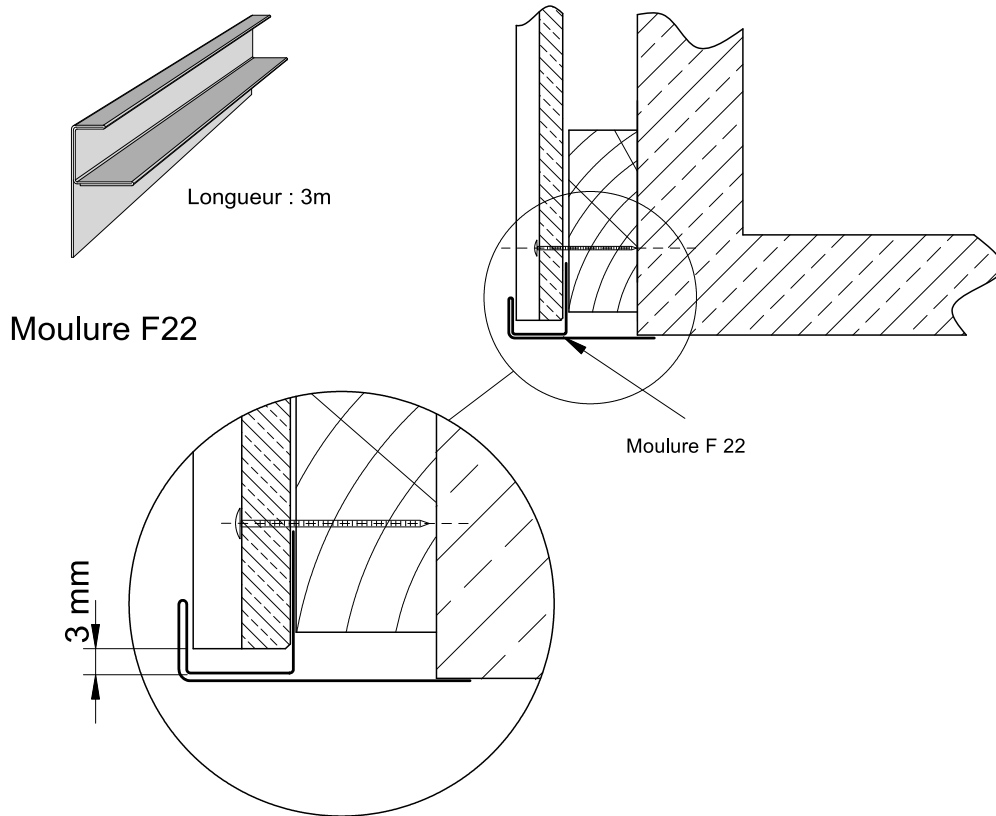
Arrêt sur revêtement - Moulure F22 – Coupe horizontale
